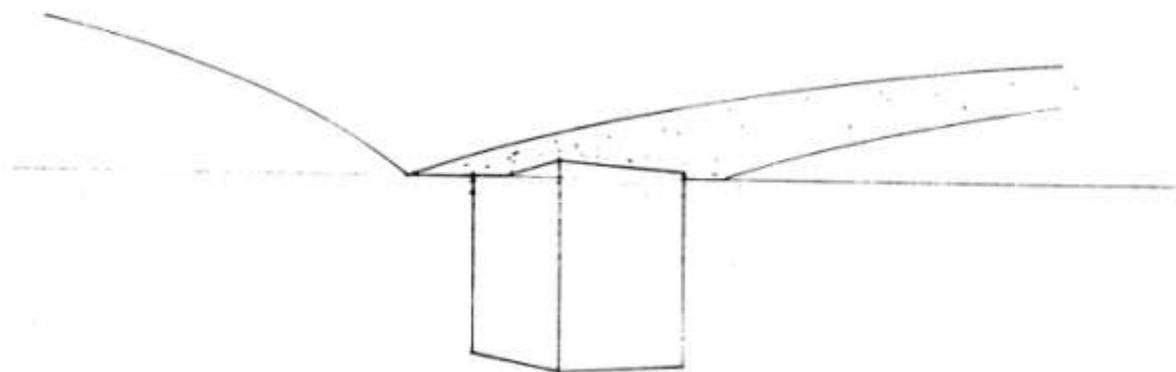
Croqui Niemeyer: encontro da ponte com os blocos de fundação, o afastamento do perfil da ponte do bloco de fundação garantiria a sensação de flutuação da ponte sobre o lago. Fonte: (DE – DVO – NOVACAP, 1969).
